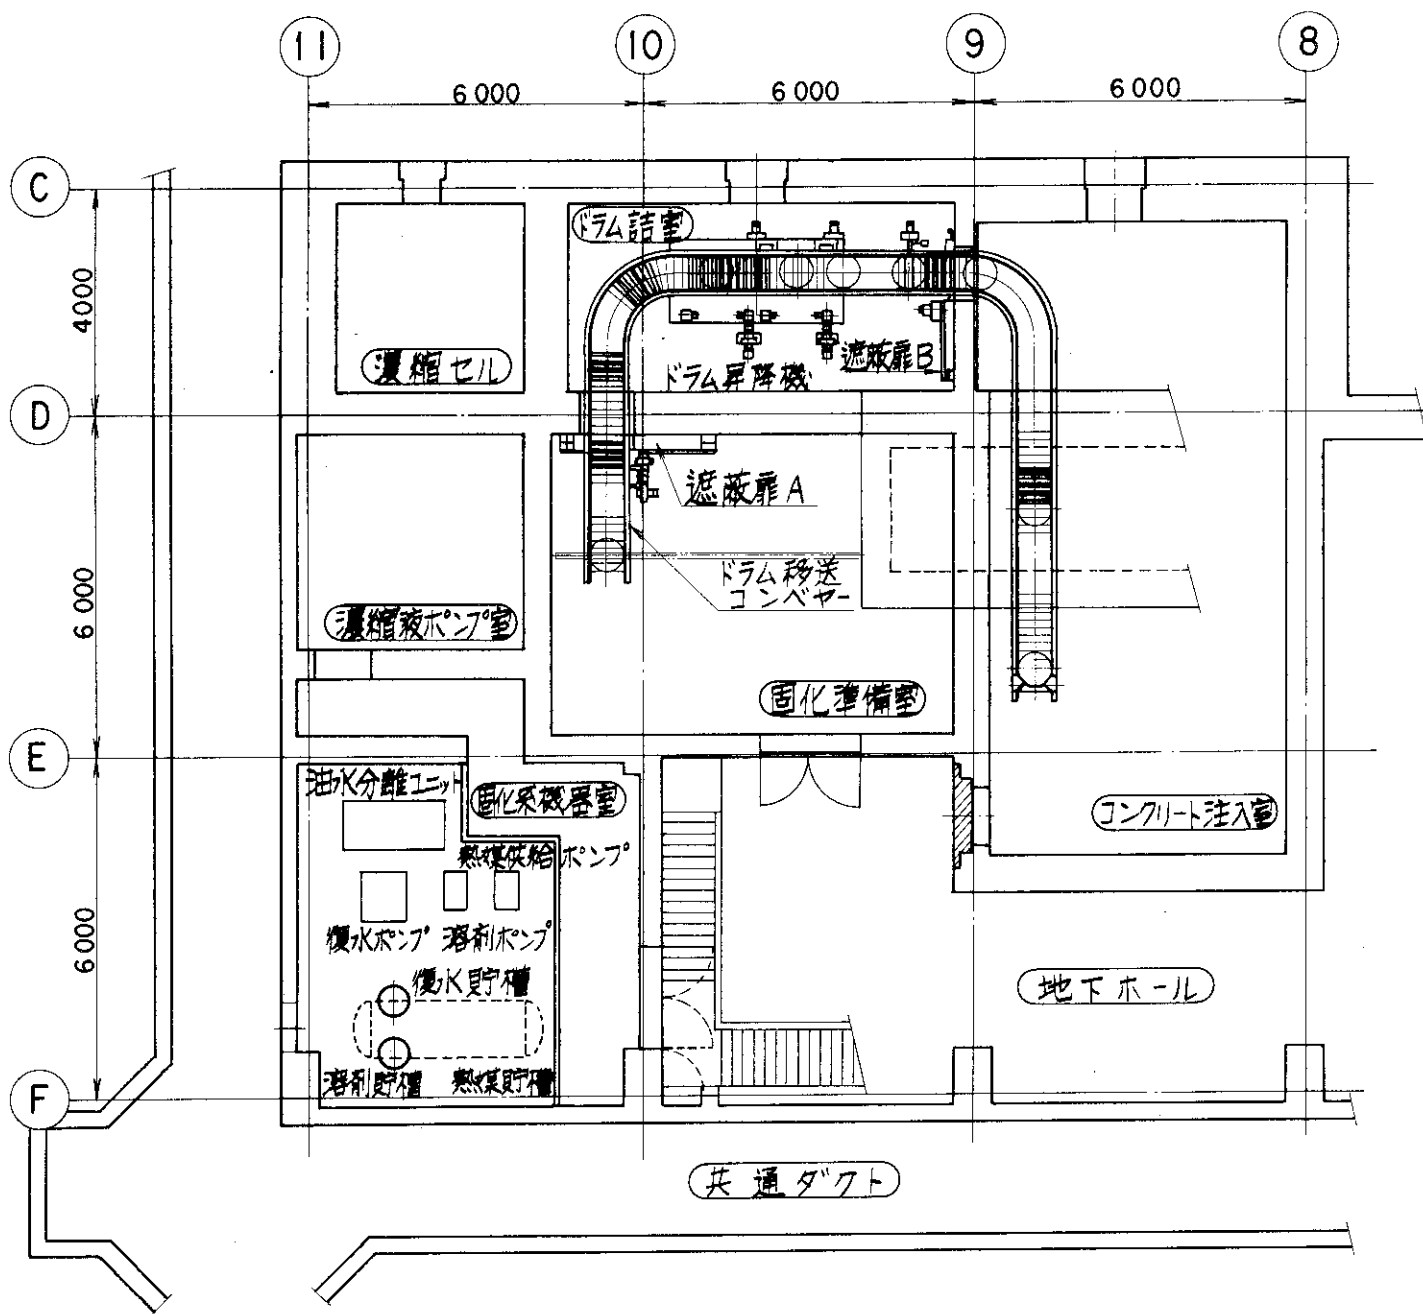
アスファルト固化処理設備機器配置図 (その 3) 地階平面
